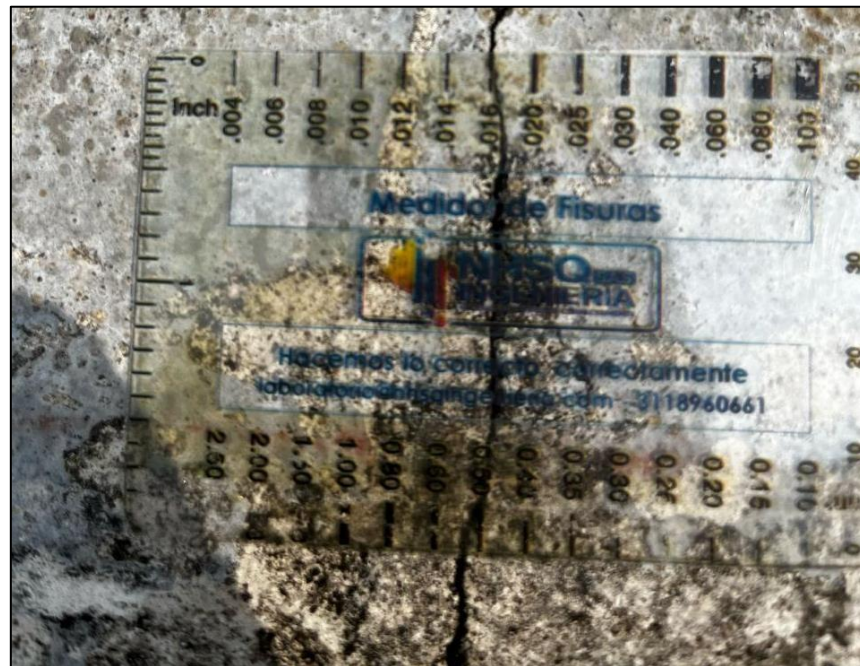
Fisurómetro para medir ancho de fisuras (fuente propia)
